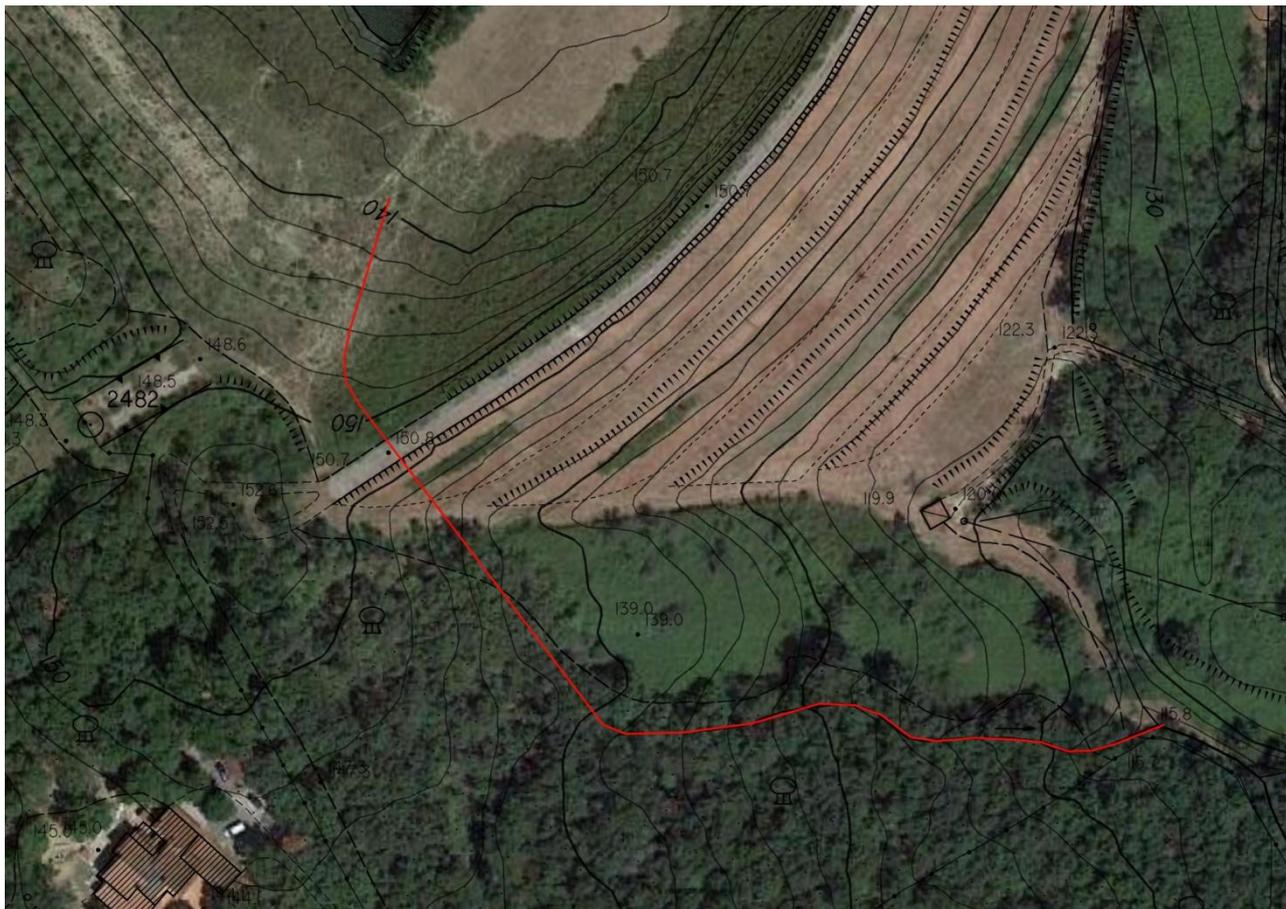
Planimetria recapito alternativo scarico di superficie
